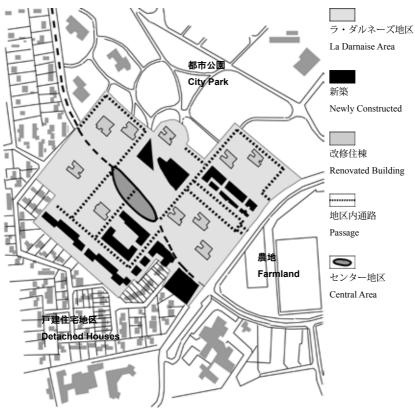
ラ・ダルネーズ地区の配置図 / Plot Plan of La Darnaise
